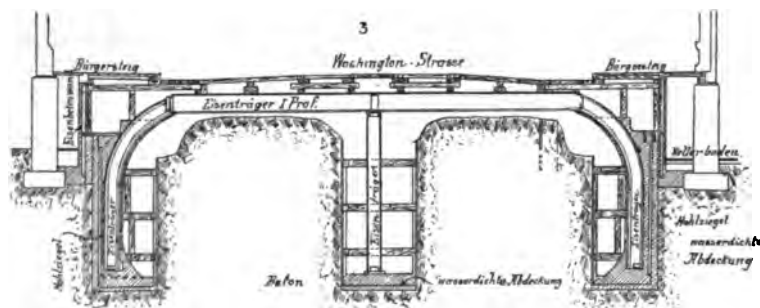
Querschnitt durch die Bausektion 10 der Bostoner Untergrundbahn während der Ausführung.
